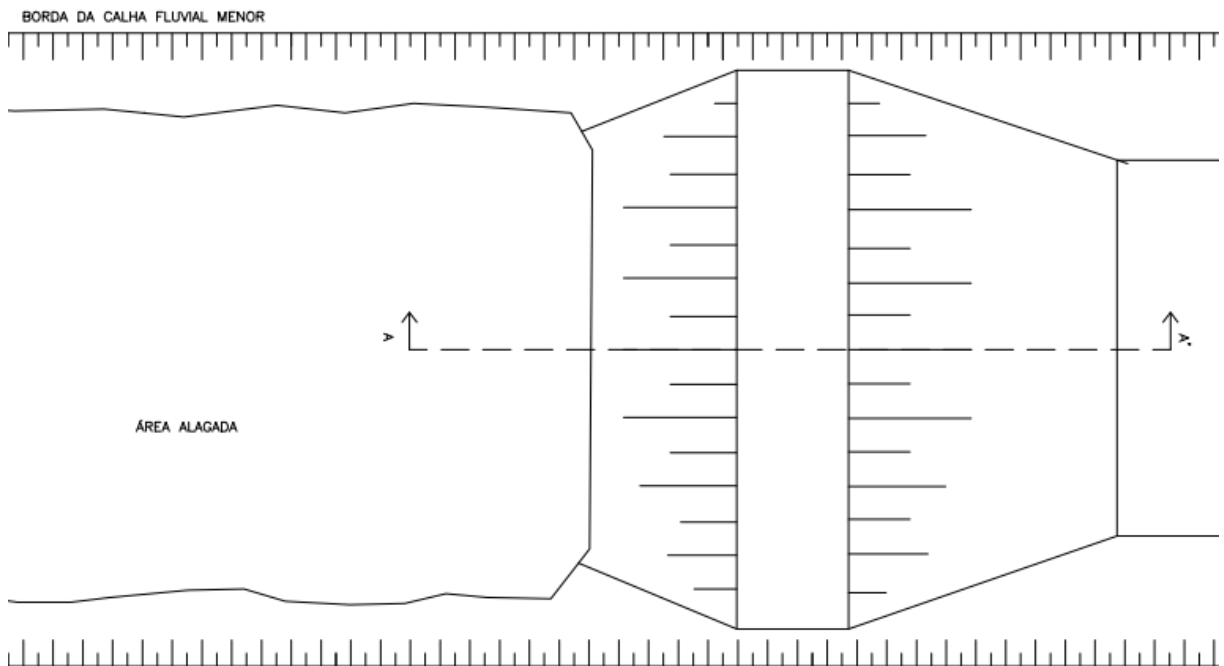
Vista superior de detalhe de construção dos barreiros.
